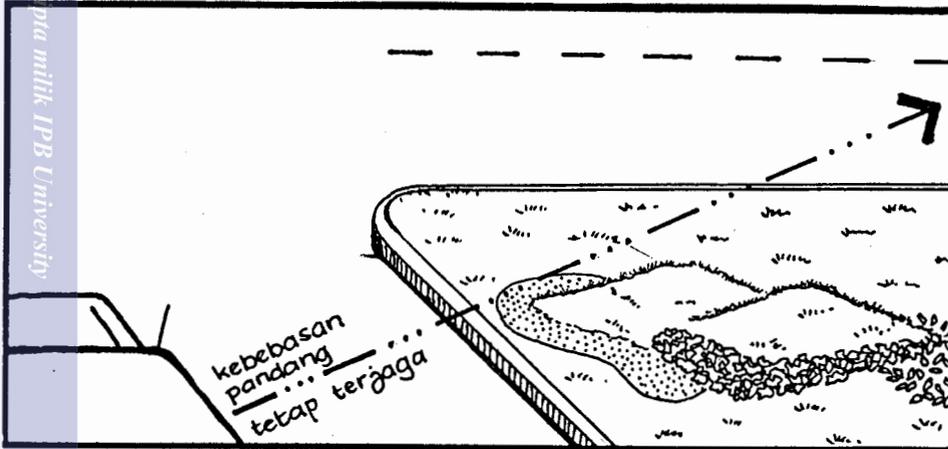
Zona Bebas Halangan Tanpa Kehadiran Elemen Vertikal Yang Menghalangi Pandangan.
